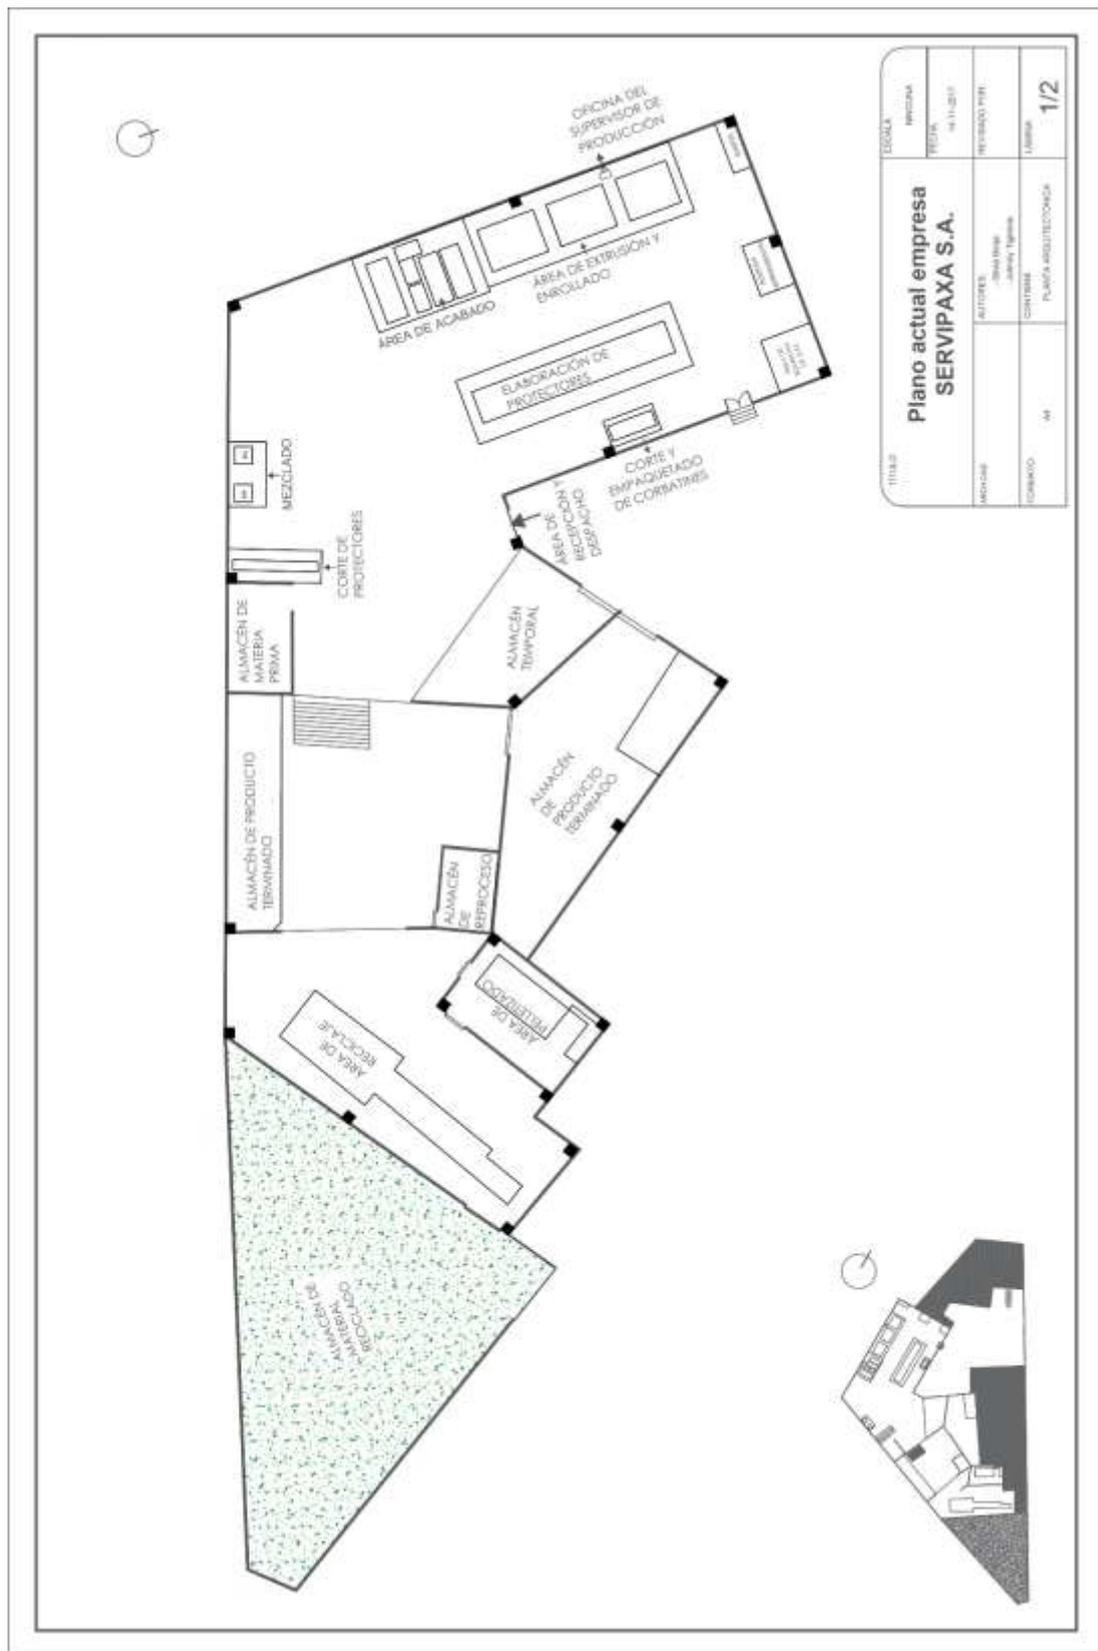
Diseño actual de la planta SERVIPAXA S.A.
